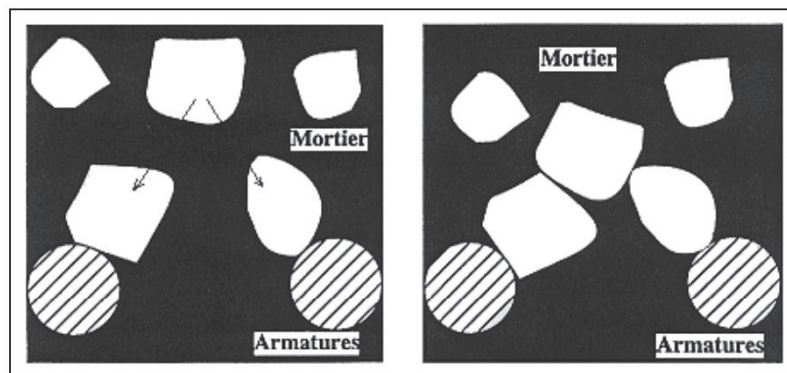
Représentation en plan d'un blocage de granulats à travers deux armatures [52].
